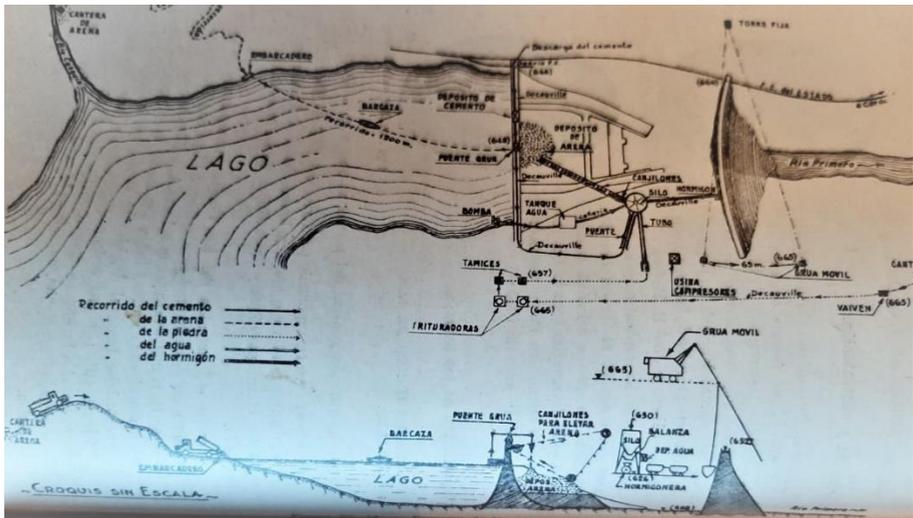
Plano de construcción del Dique San Roque, Usinas y canales de riego. Fuente: Revista El Ingeniero N° 60-67. Córdoba 1945.
